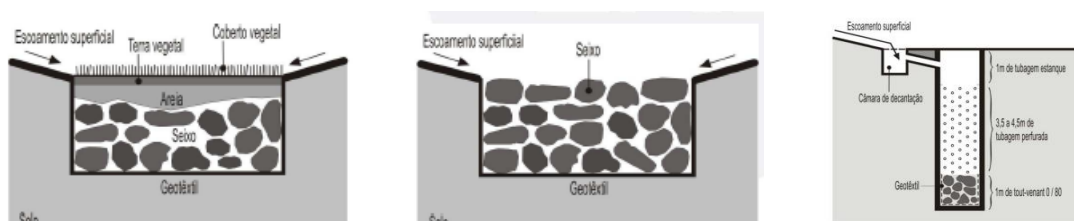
Pormenores de construção de trincheiras verdes e de calhau rolado (esq. e meio), e de poço de infiltração. Fonte: Matos (2008).
